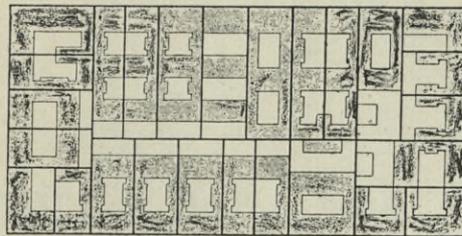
Neuer Berliner Baublock. 1:4000. Für die Hofflächen ist ein bestimmtes Verhältnis gegenüber der Gesamtfläche vorgeschrieben. Um mehr Luft und Licht zu gewinnen, werden außerdem die benachbarten Höfe zusammengelegt
